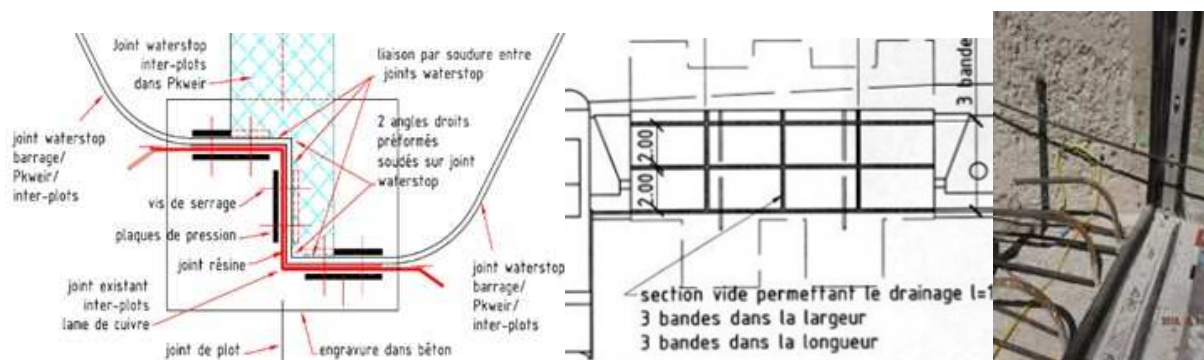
a) Principe de rattachement entre joint de cuivre et waterstop, b) exemple de vue en plan du dispositif de drainage à l'interface PKW – barrage, c) exemple de waterstop entre PKW et barrage
